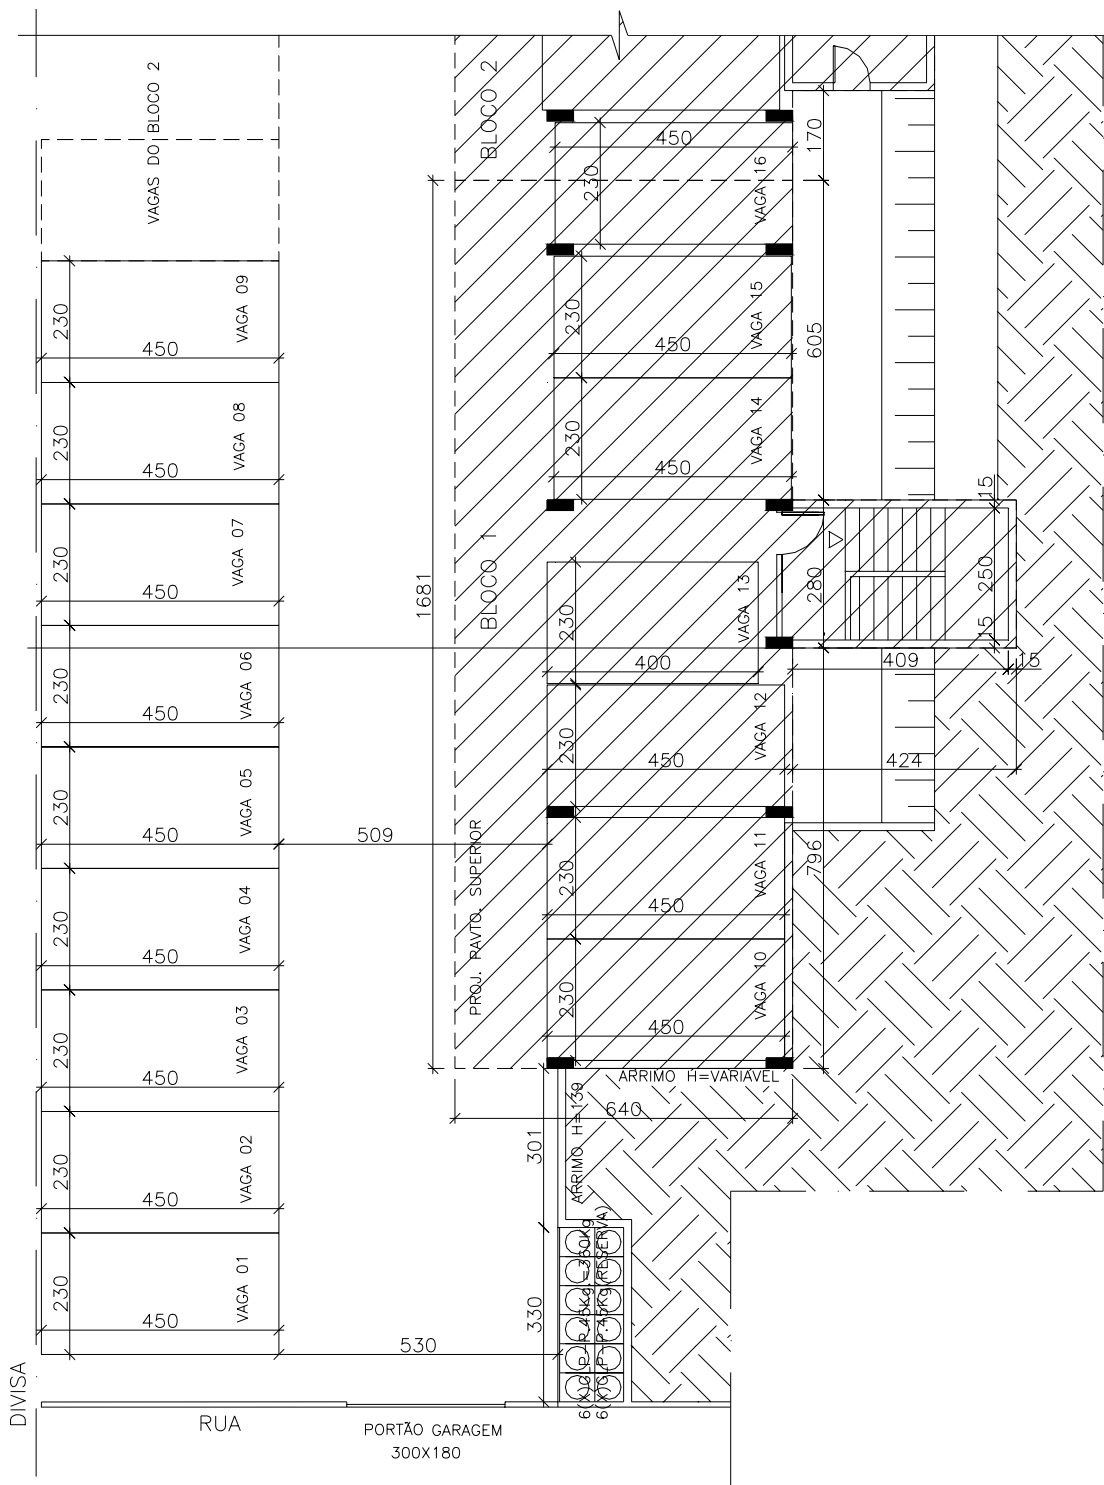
Residencial “S” – Projeção do pavimento tipo sobre as garagens
